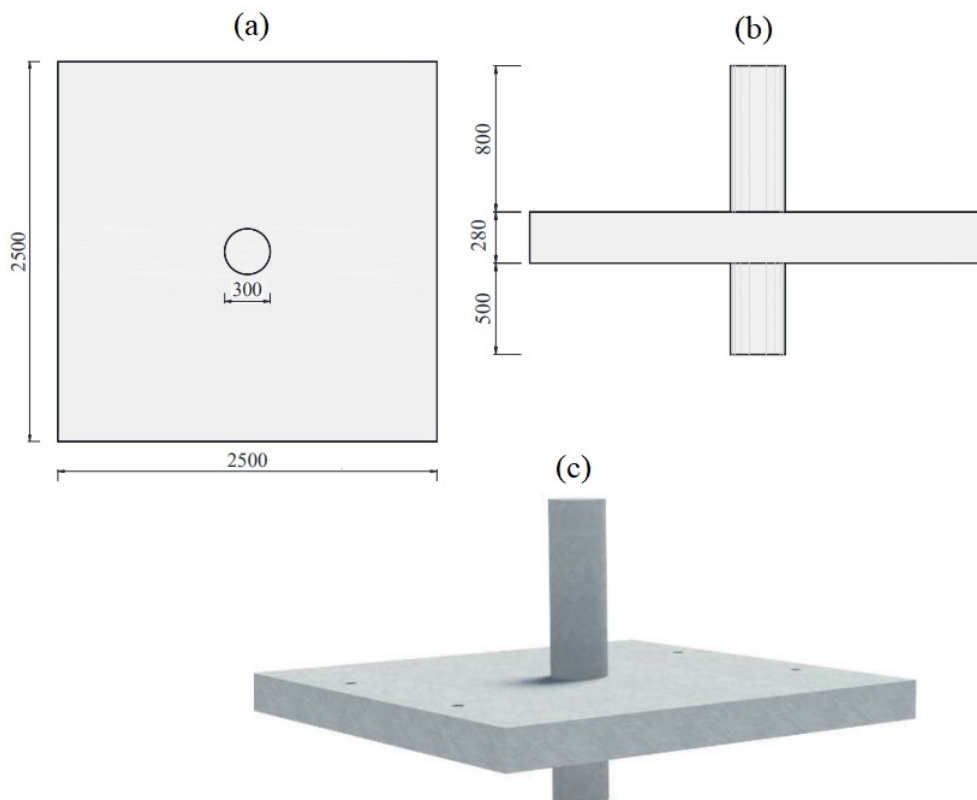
Laje experimental: planta (a), corte (b) e esquema 3D (c) (dimensões em mm) (fonte: Nicácio (2018))
